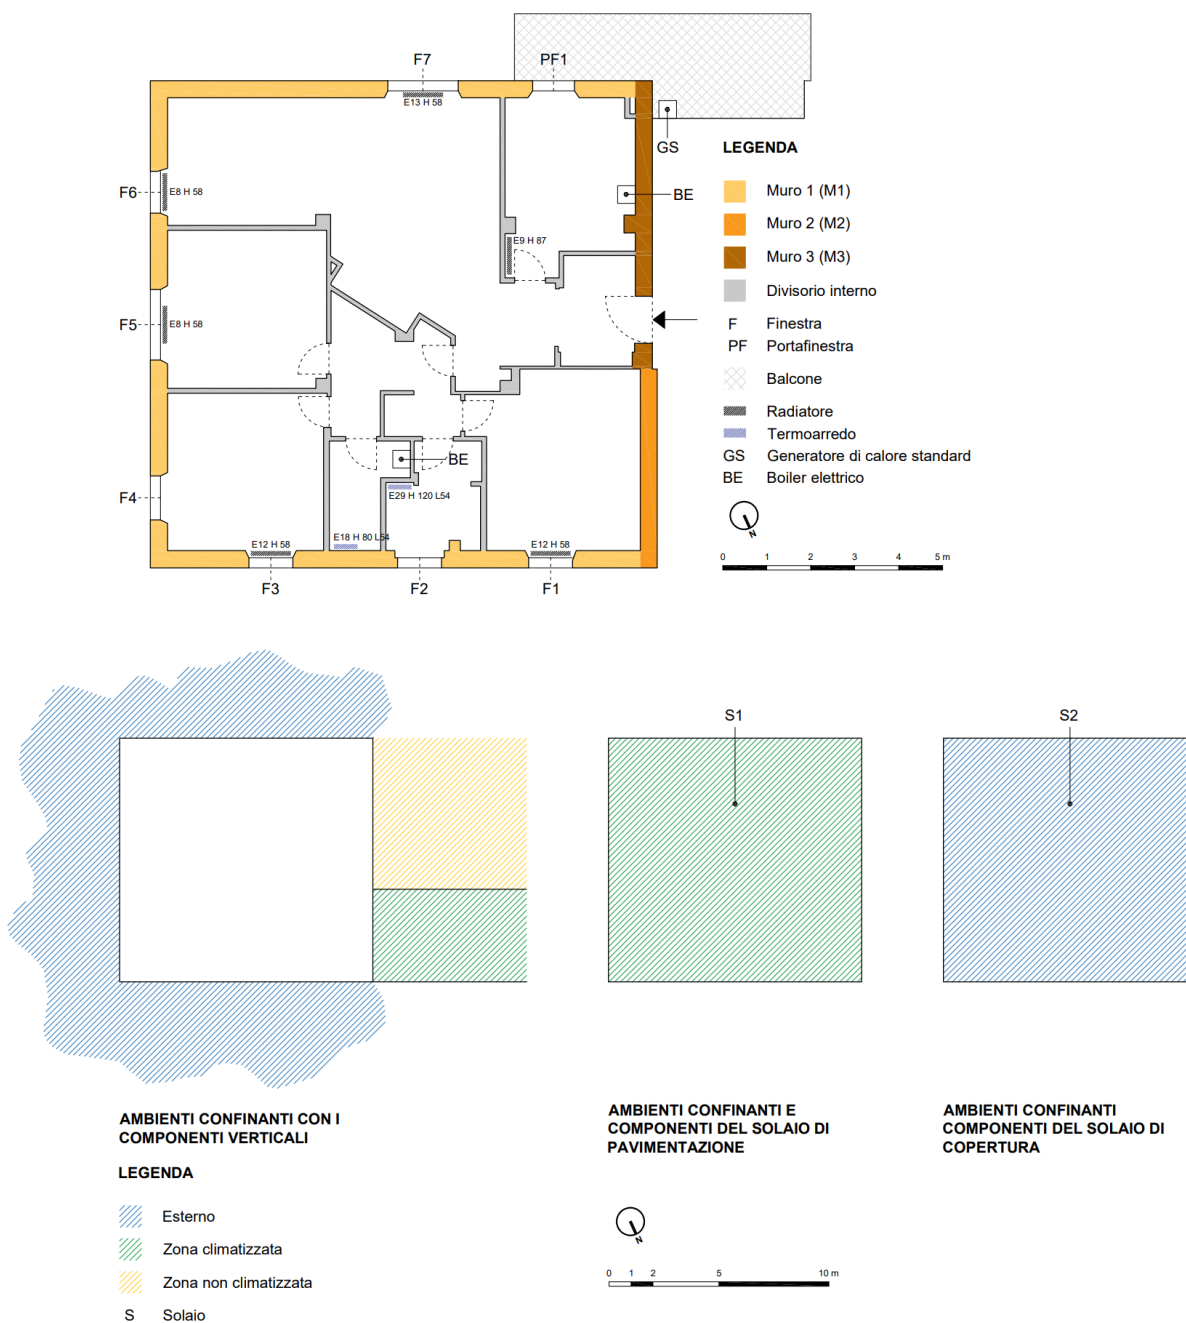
Caratterizzazione geometrica e individuazione delle zone confinanti.
